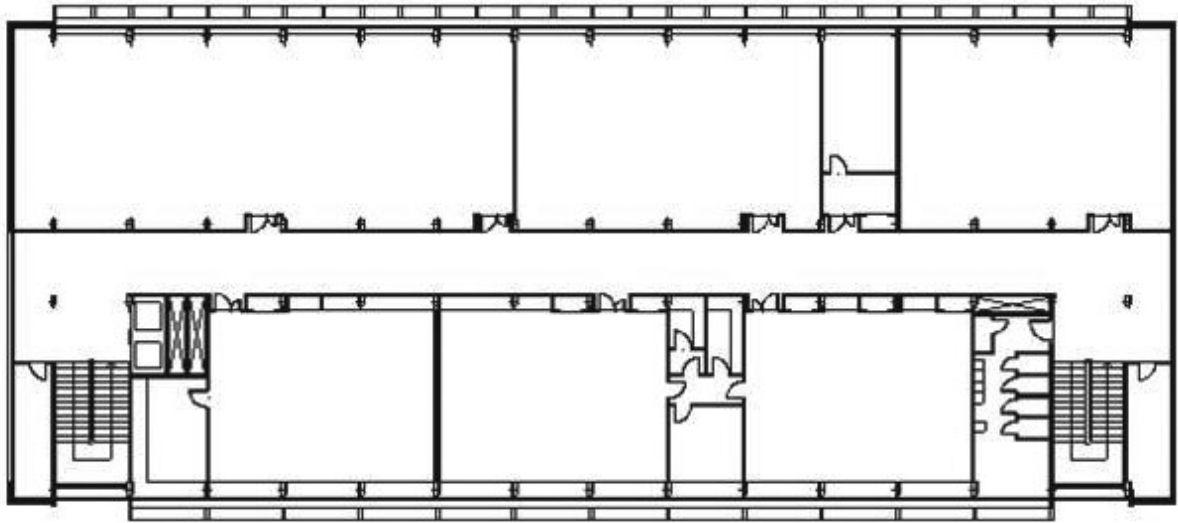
Planta tipo. Imagen: Begoña Serrano Lanzarote.
